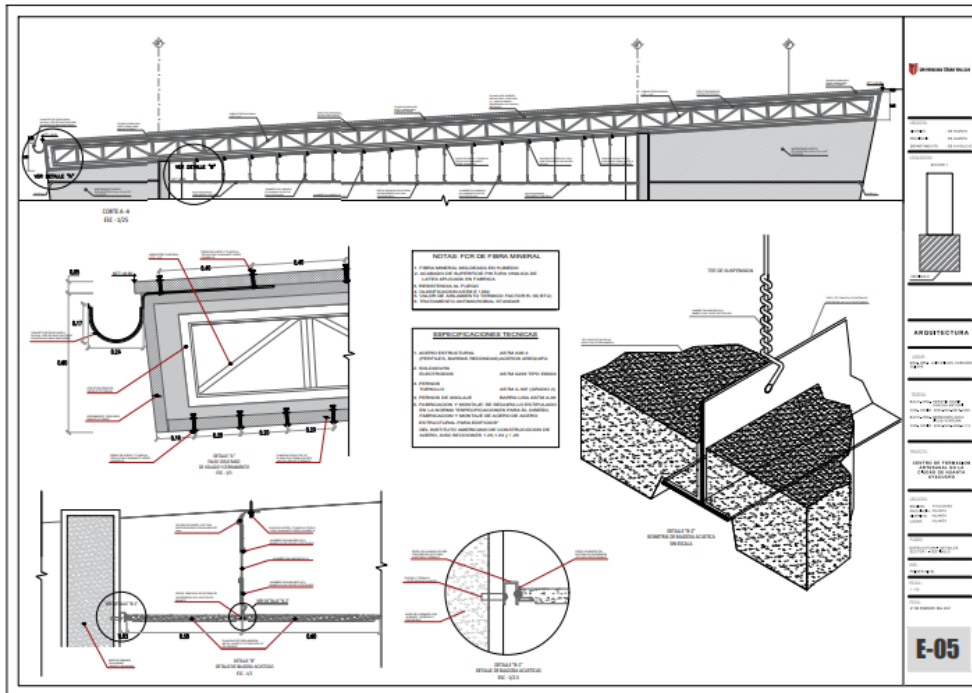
Plano de estructura en corte de la cubierta - escala 1/25.
